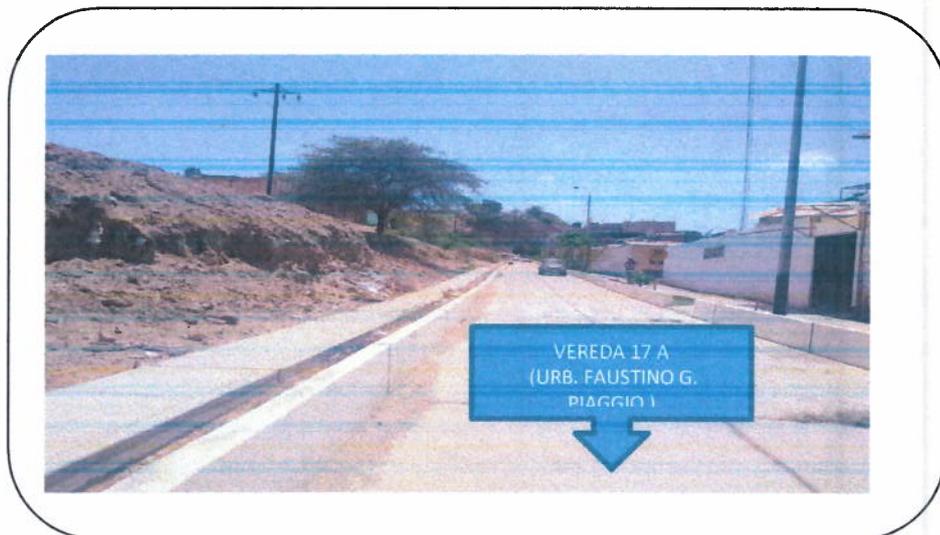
ACCESO POR CALLE VEREDA17 A-URB. FAUSTINO G. PIAGGIO
